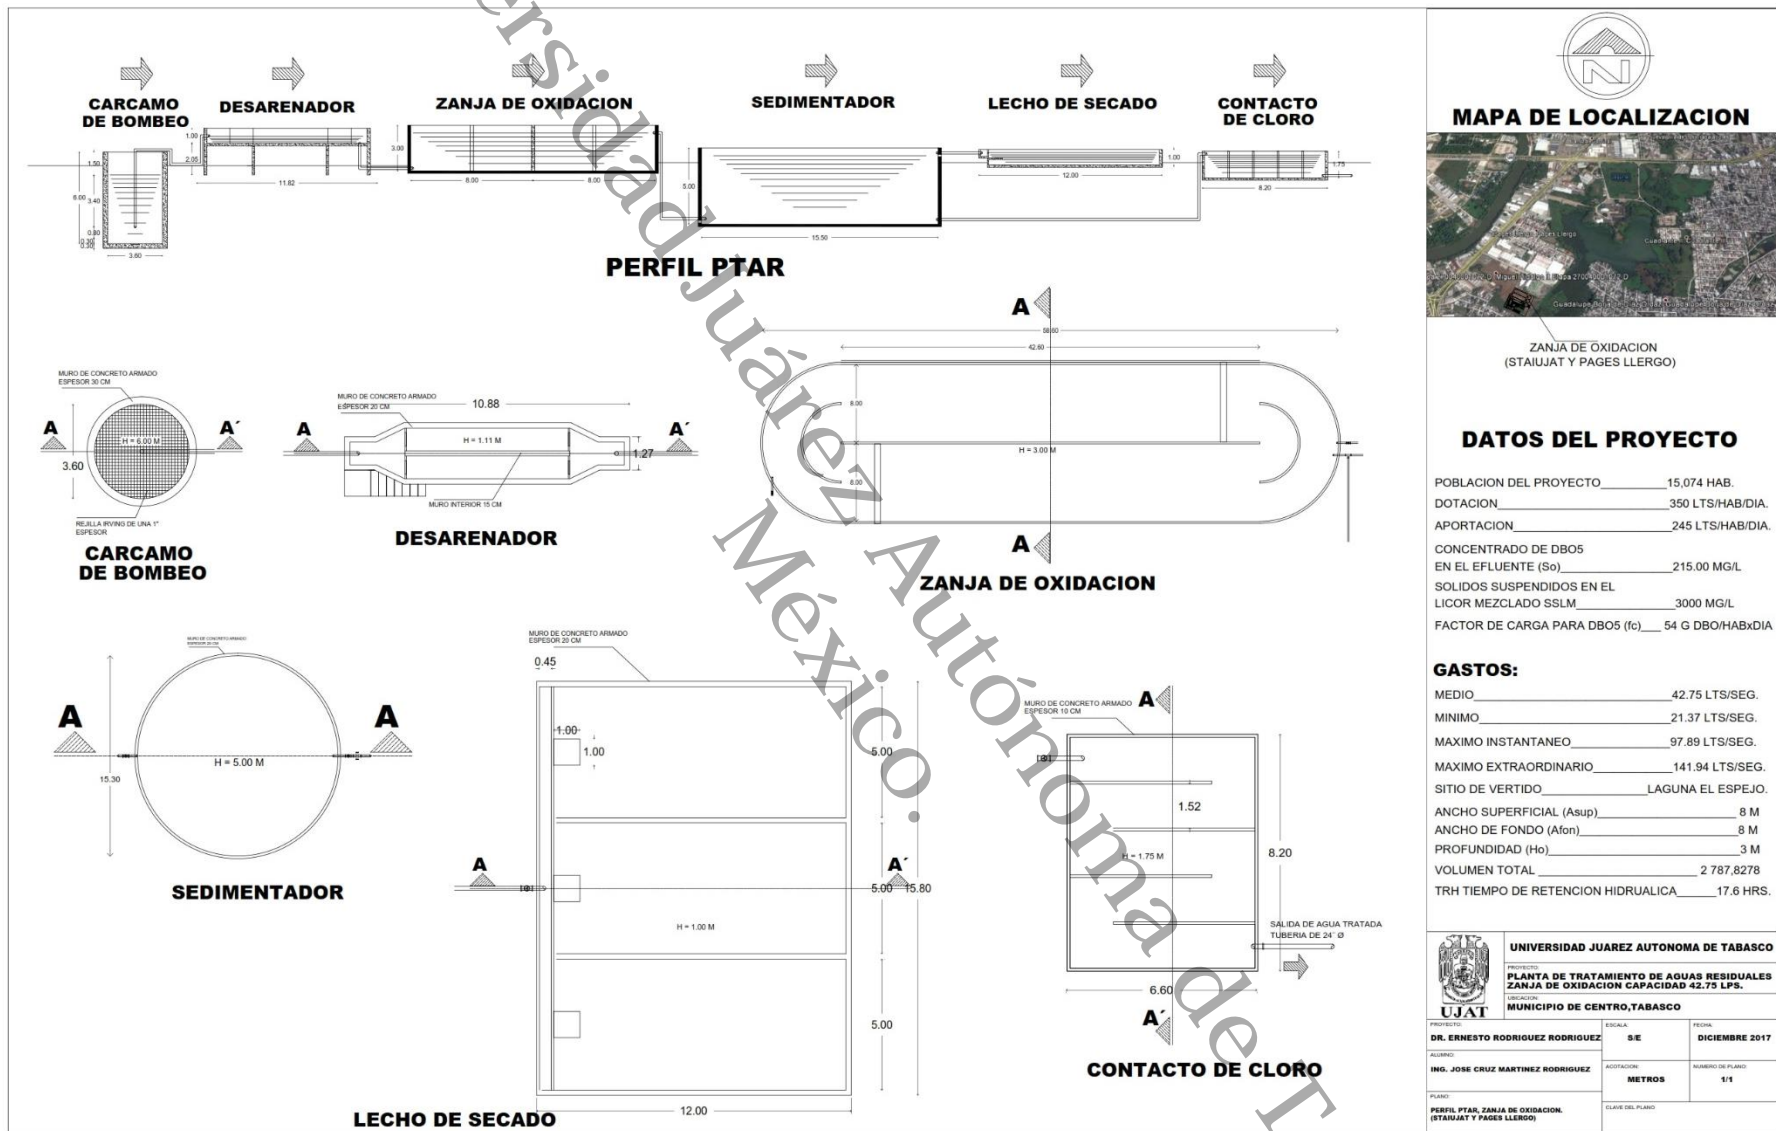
Plano perfil PTARD Zanja de Oxidación 1, Pagés Llergo y STAIUJAT.
